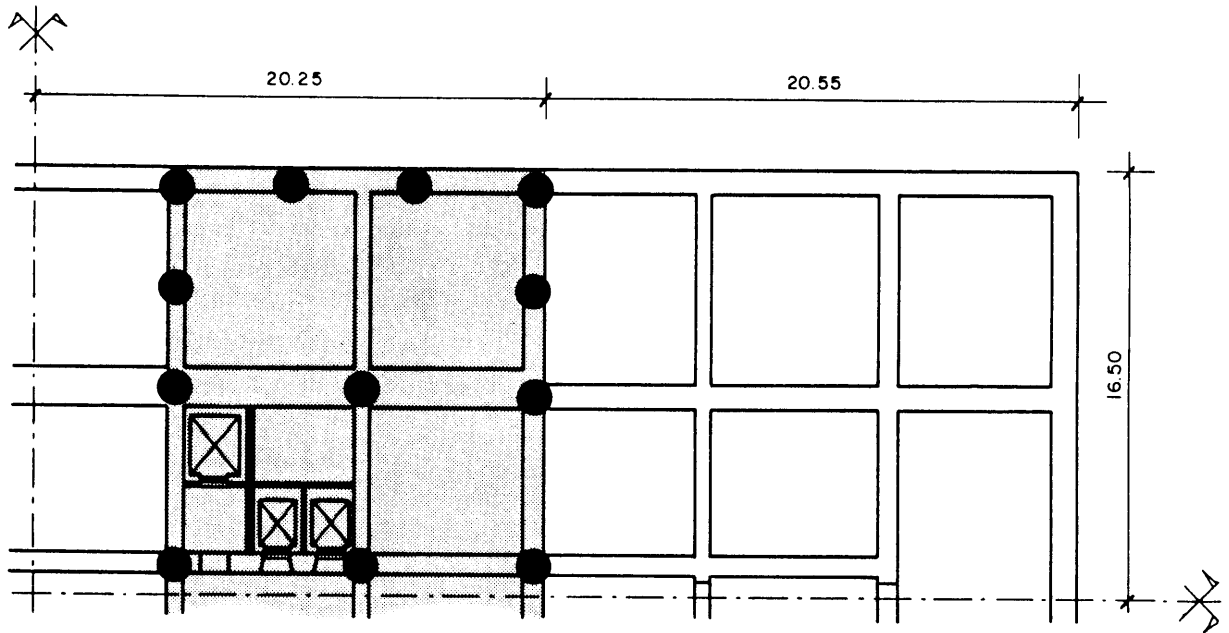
Grundriß des Fundationskastens mit Pfahlanordnung
